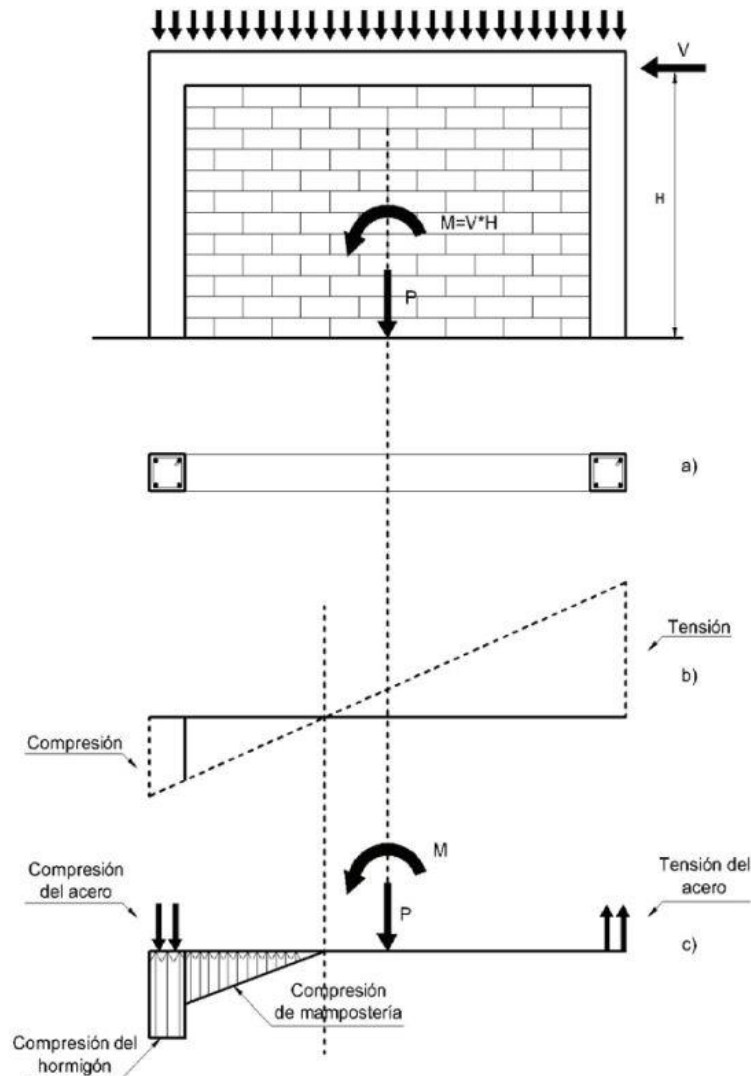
Detalle del Panel de Mampostería Confinada sujeto a acción combinada de carga axial y lateral
